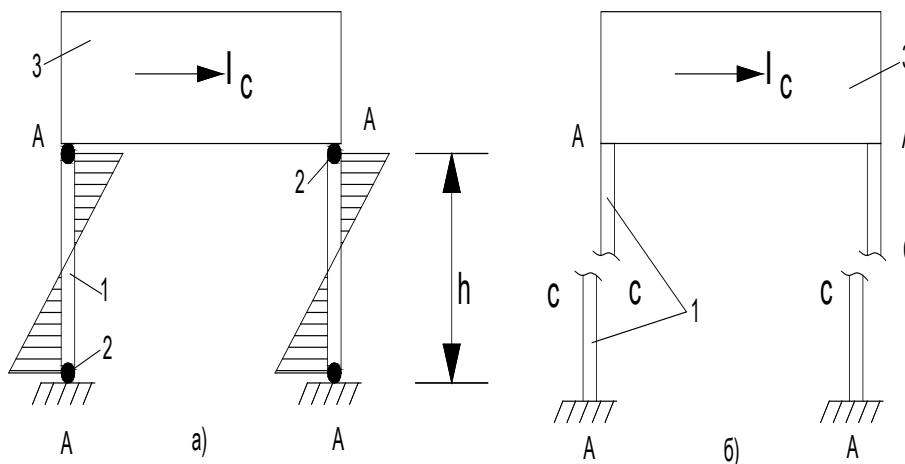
Расчетная схема здания с гибким каркасным первым этажом:
